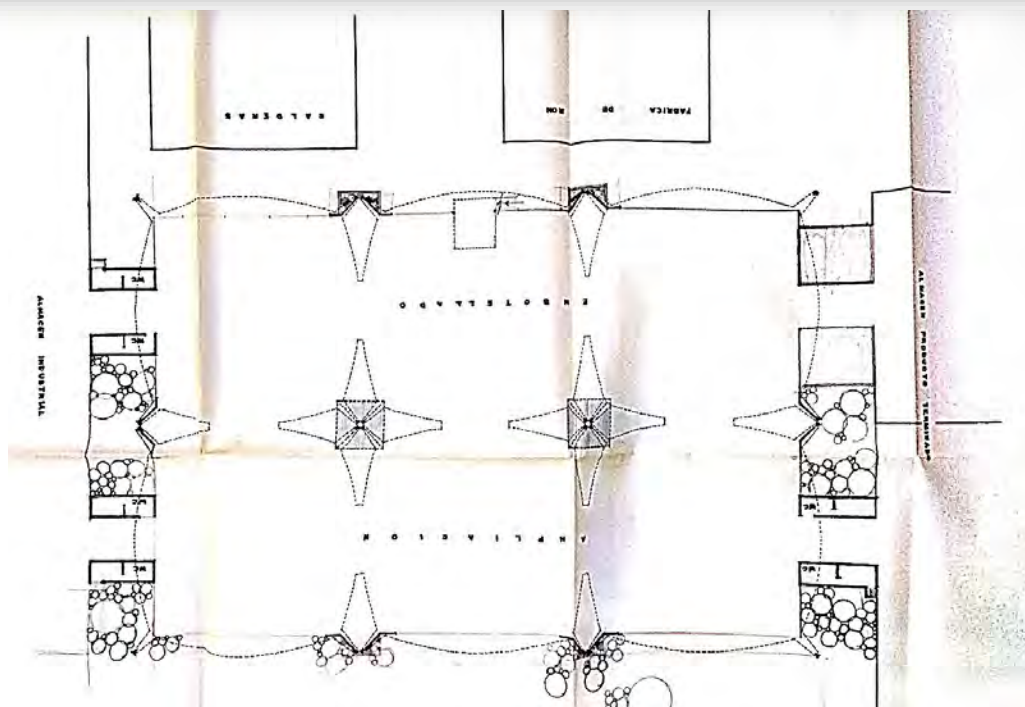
Planta Proyecto Ampliación Planta Embotelladora Bacardí, Arq. Enrique de la Mora y Palomar
